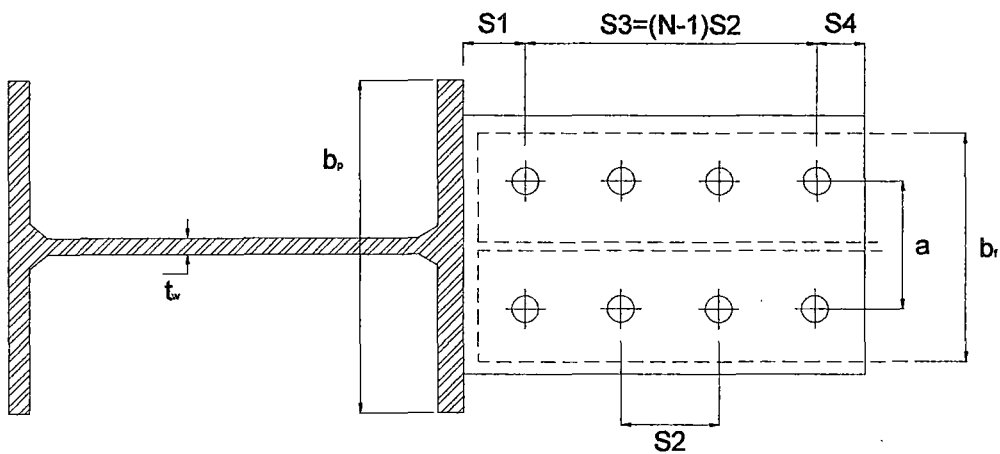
Detalle de vista en planta de la Conexión BFP
